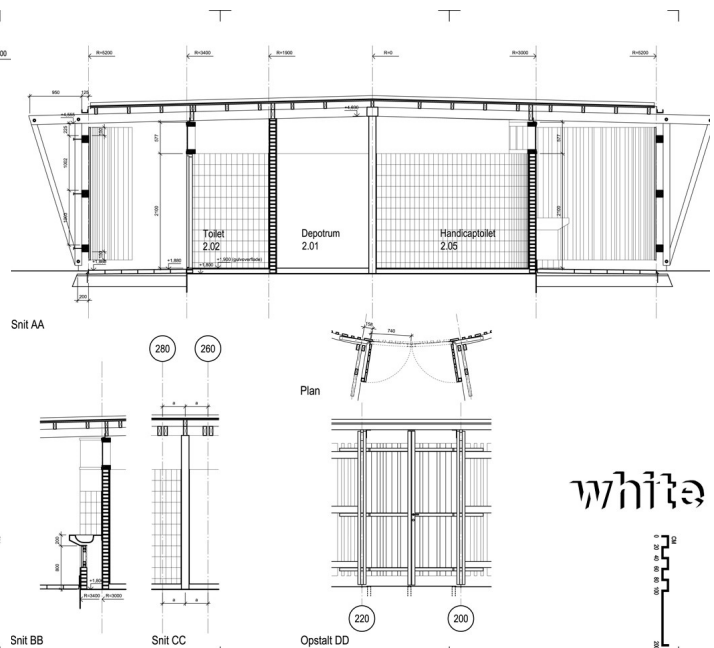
Sección constructiva del pabellón de tierra con los aseos. Los cerramientos y paredes son de madera y la estructura es metálica también.
